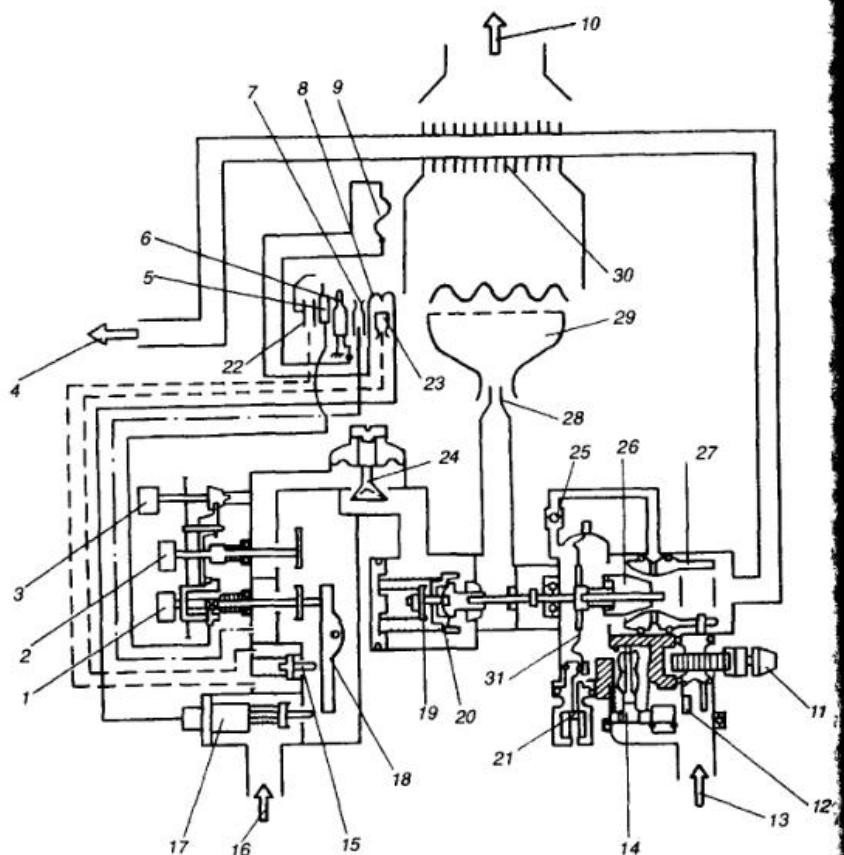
Устройство блока автоматики водонагревателя ВПГ-20-В1-2.23-Р-Р2:
